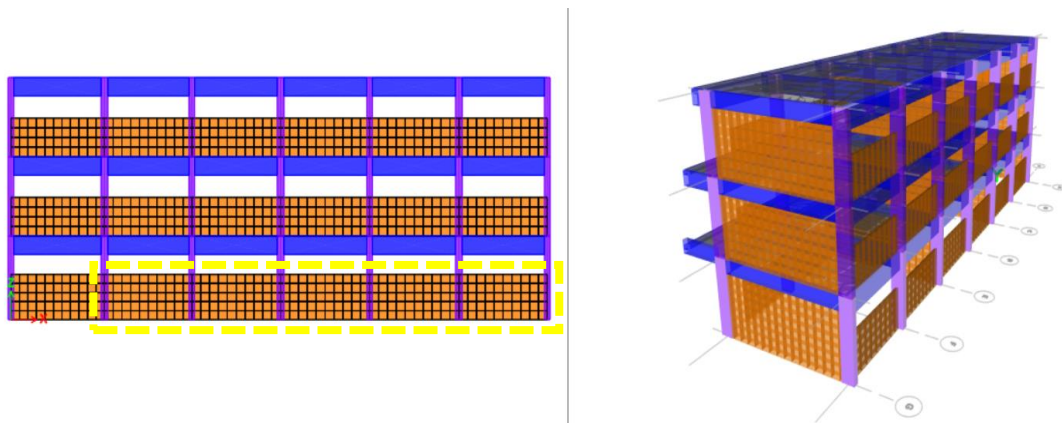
Muro fisurado AB del Piso 1, bloque 1
